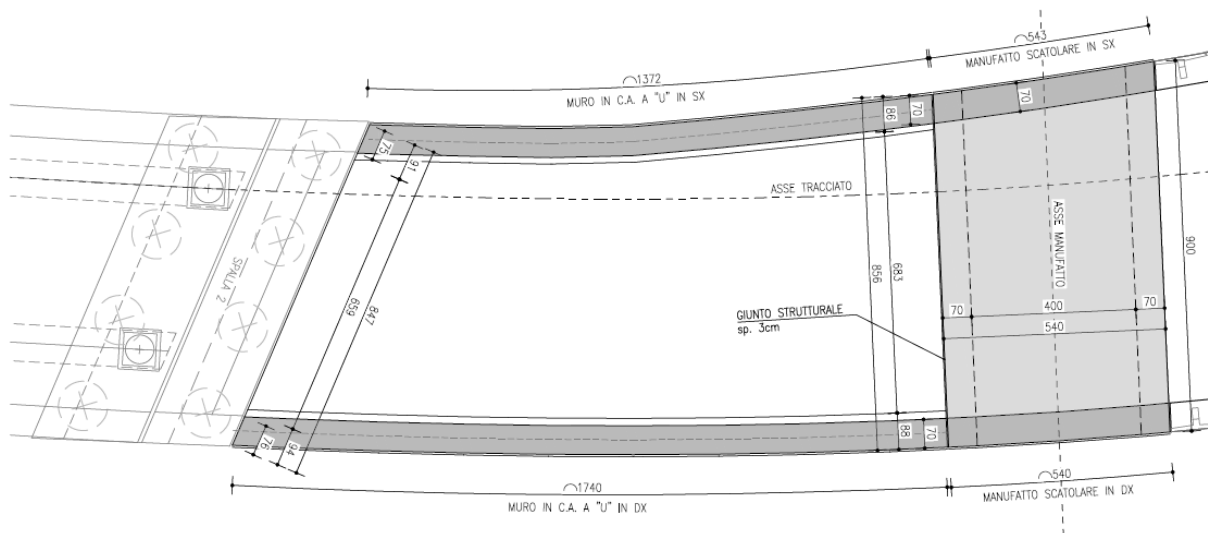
Scatolare e muro a U lato nord – carpenteria fondazioni
